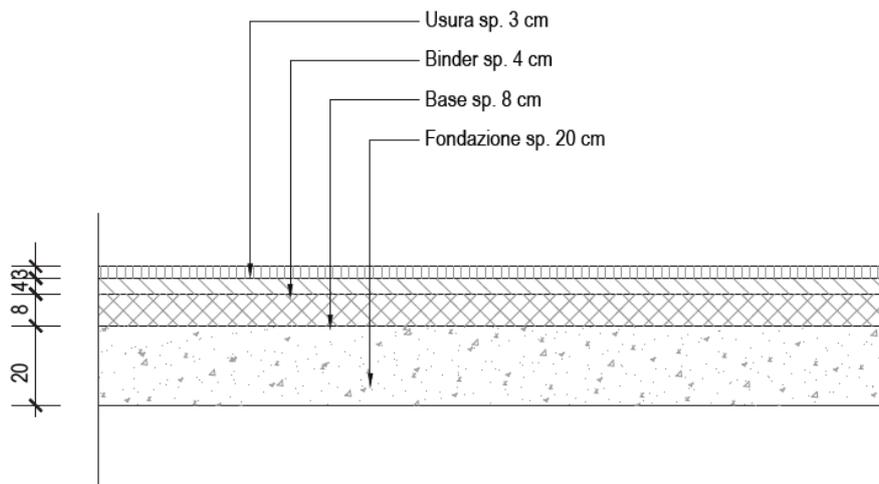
Pacchetto di pavimentazione NV04.1 e Viabilità parcheggio
